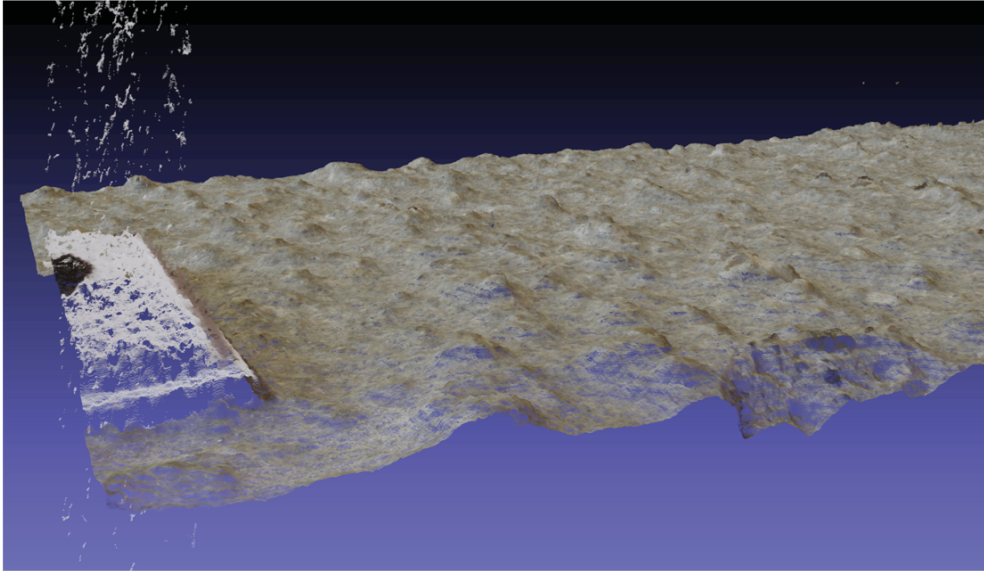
Rekonstruierte dichte Punktwolke der Betonoberfläche
